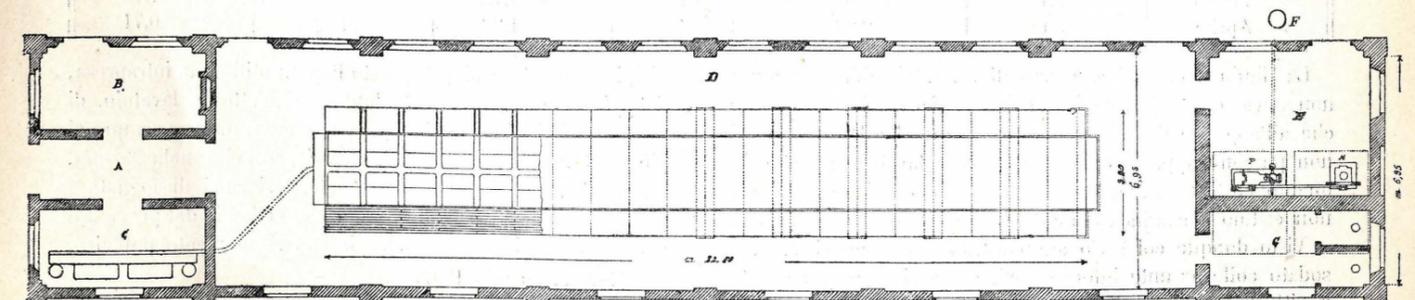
Pianta del fabbricato (Scala di 1:200).
